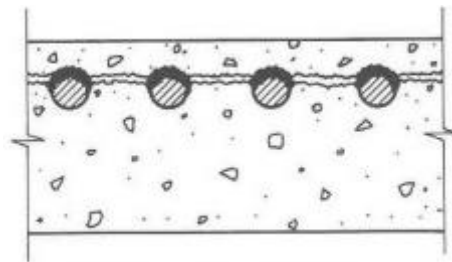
Esquema de delaminação de betão em laje por corrosão de armaduras
